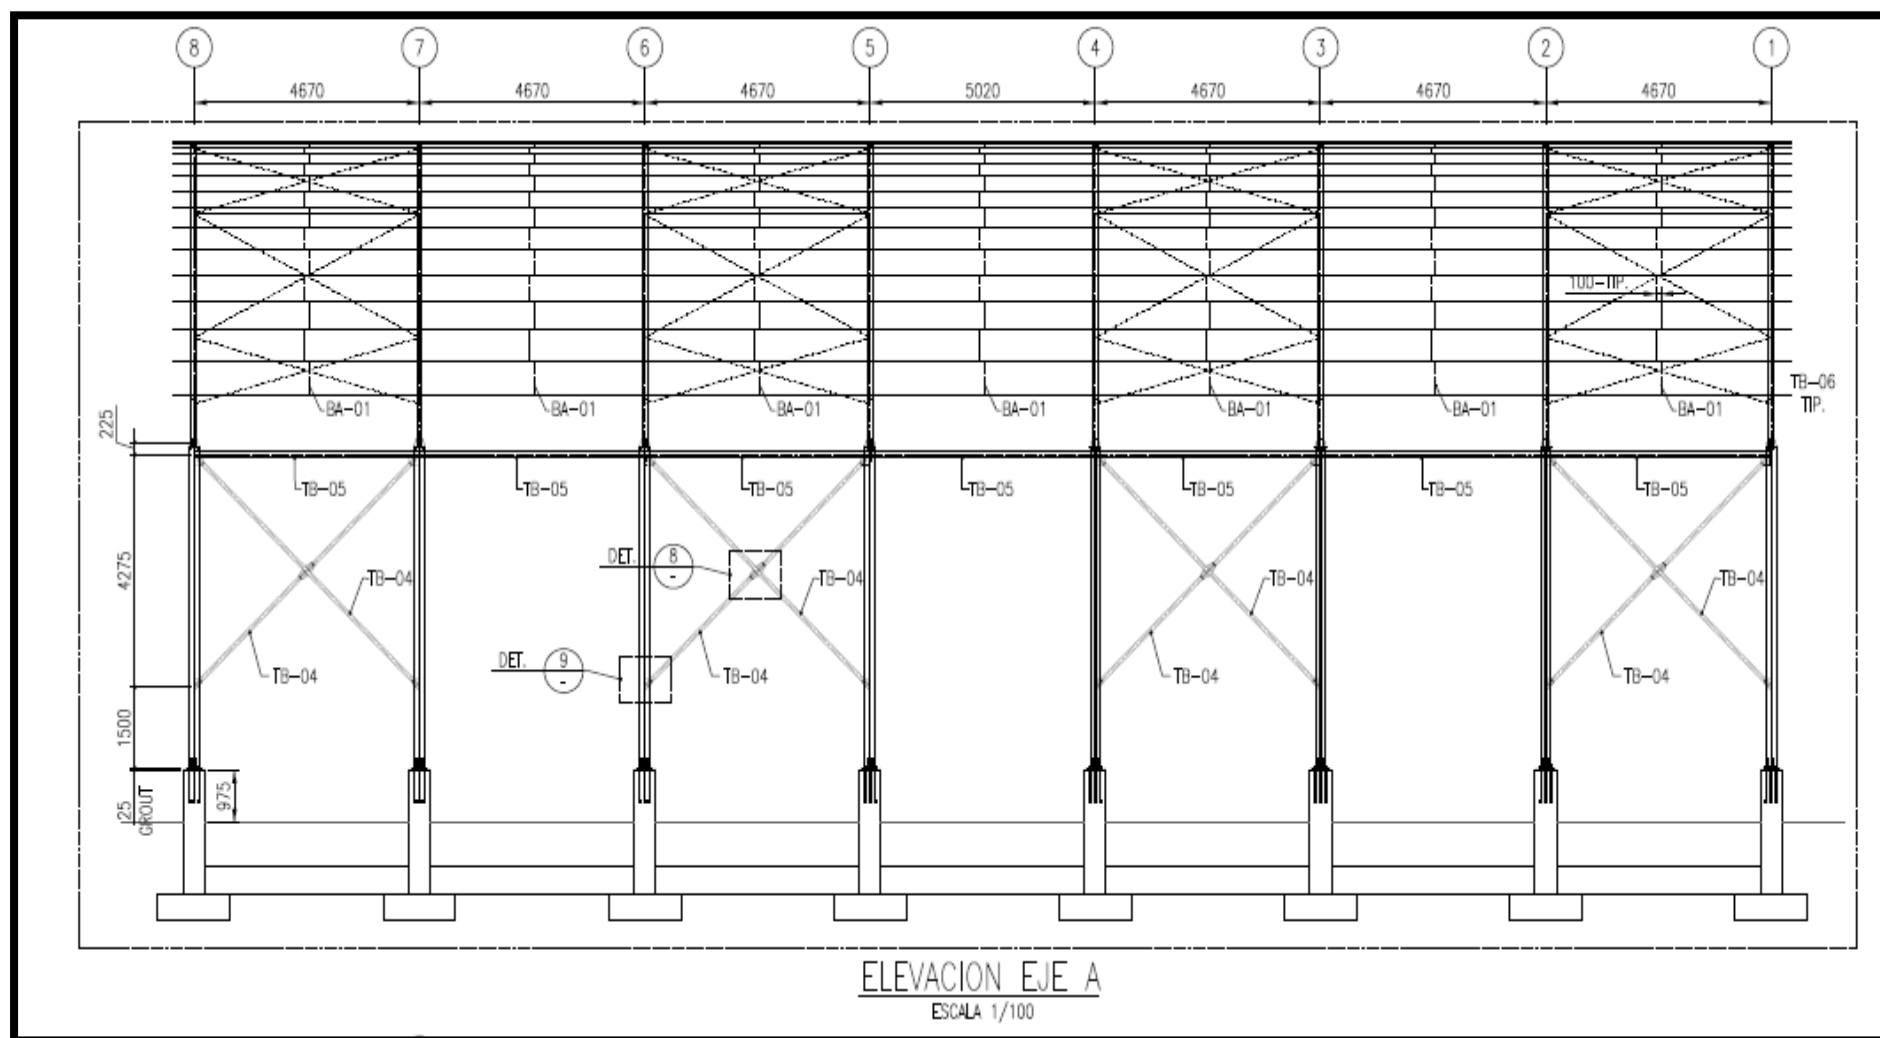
IMAGEN: VISTA PERFIL LADO DERECHO DE ESTRUCTURA METALICA EJE A-A
